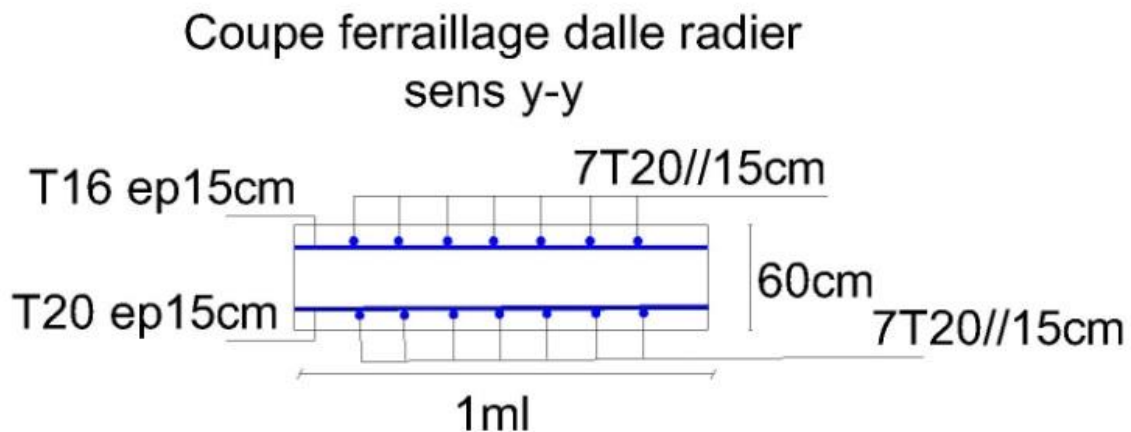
Coupe ferrailage dalle radier sens y-y
